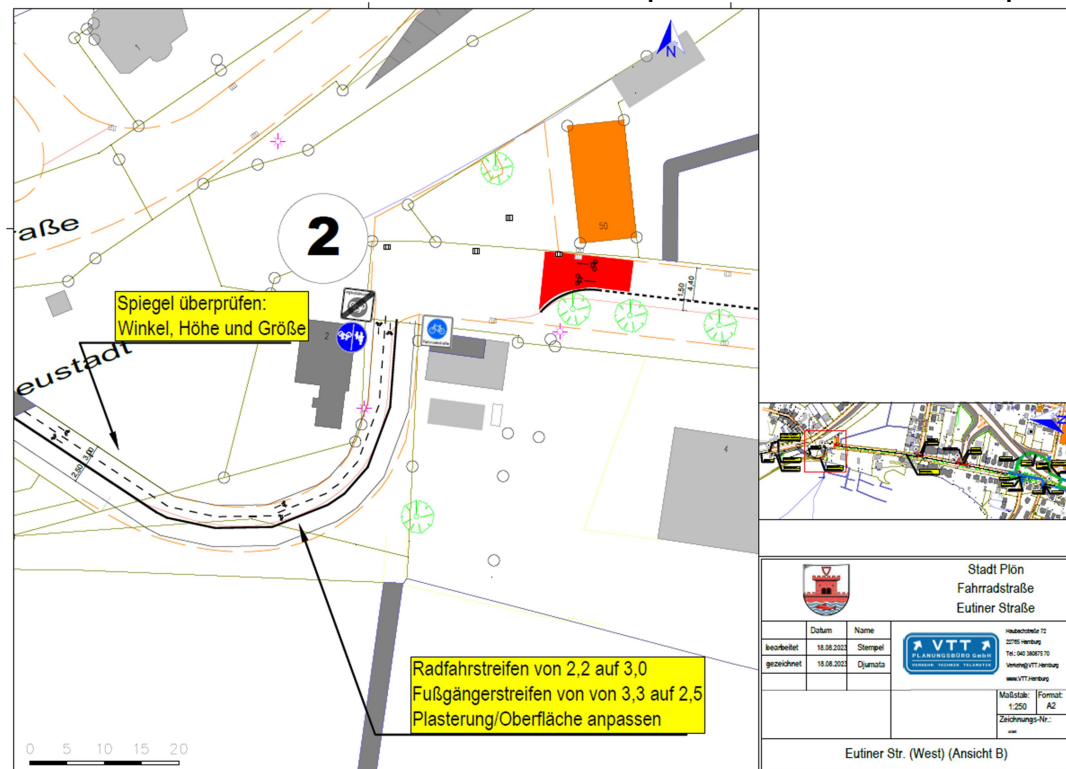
Abschnitt 2 - Anschluss Eutiner Straße mit Rampe Ost Bahnhofstunnel mit separatem Fuß- und Radweg
